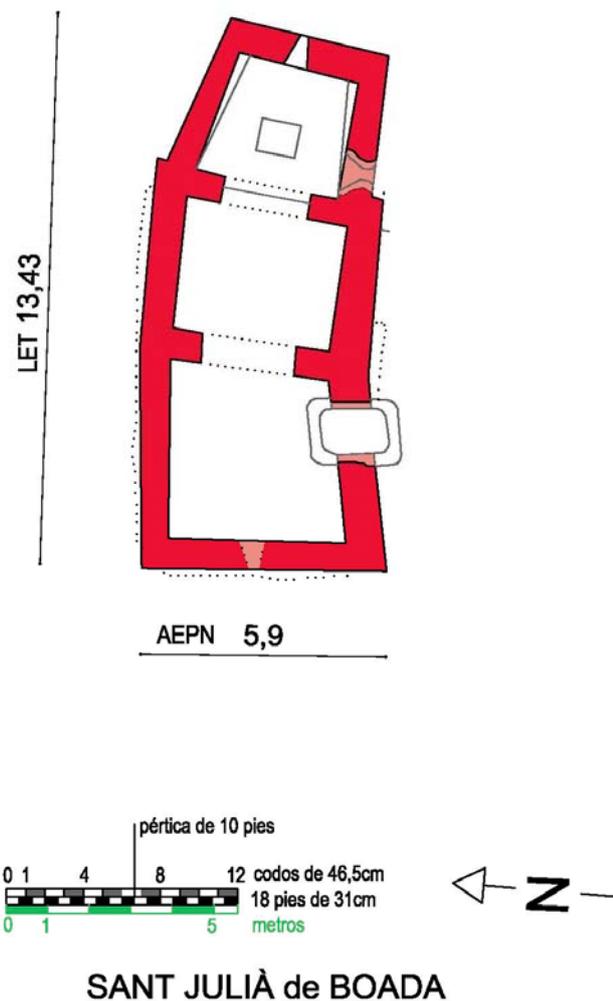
Planta crono-cromática de St. Julià. Elaborada por autora.
